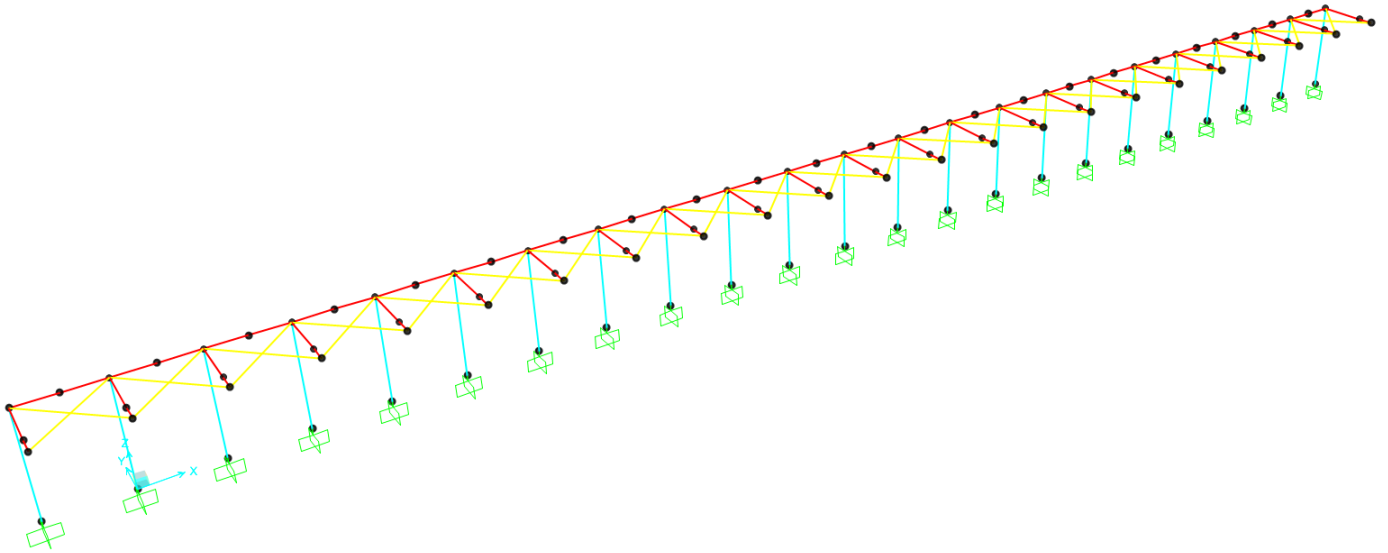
Modello SAP2000 struttura – Vista estrusa
